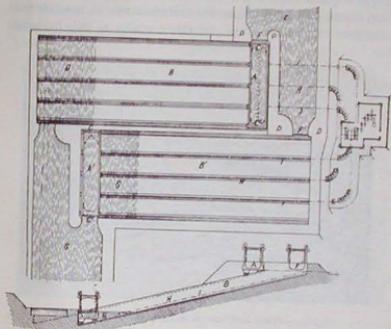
Piano inclinato di Foxton (Pianta ed elevazione).
